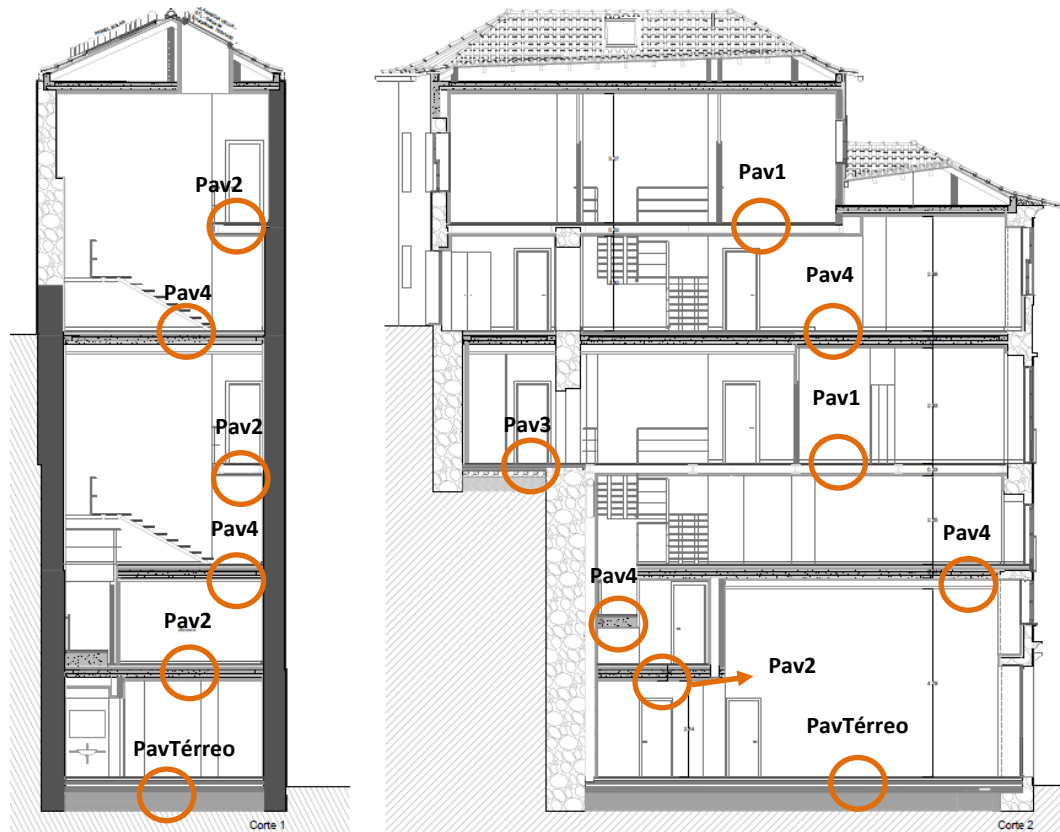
Cortes do Projeto 3 com marcação dos pavimentos [17]
